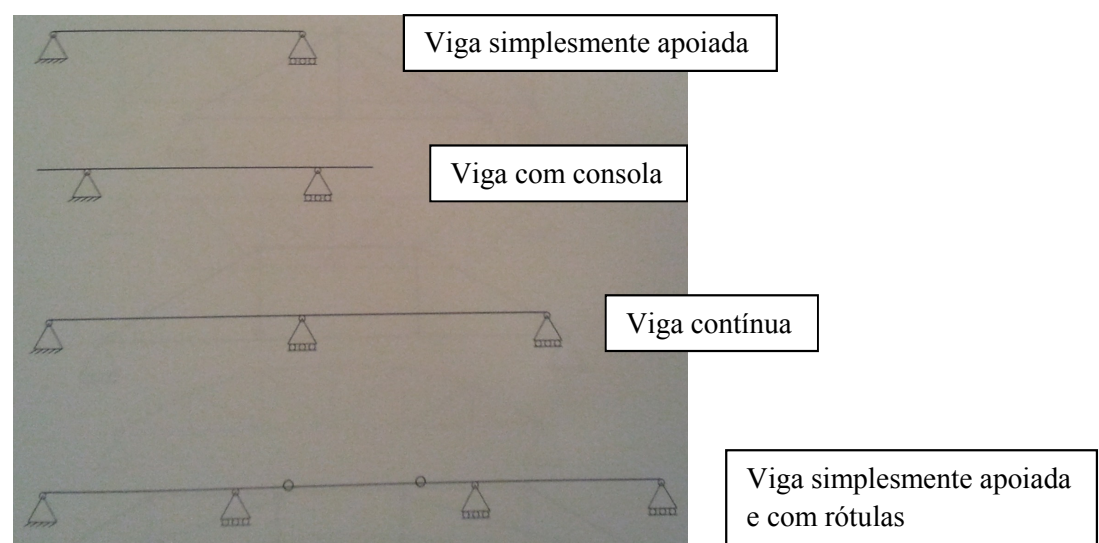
Sistema de Viga Simples (Schwaner, 2004)
